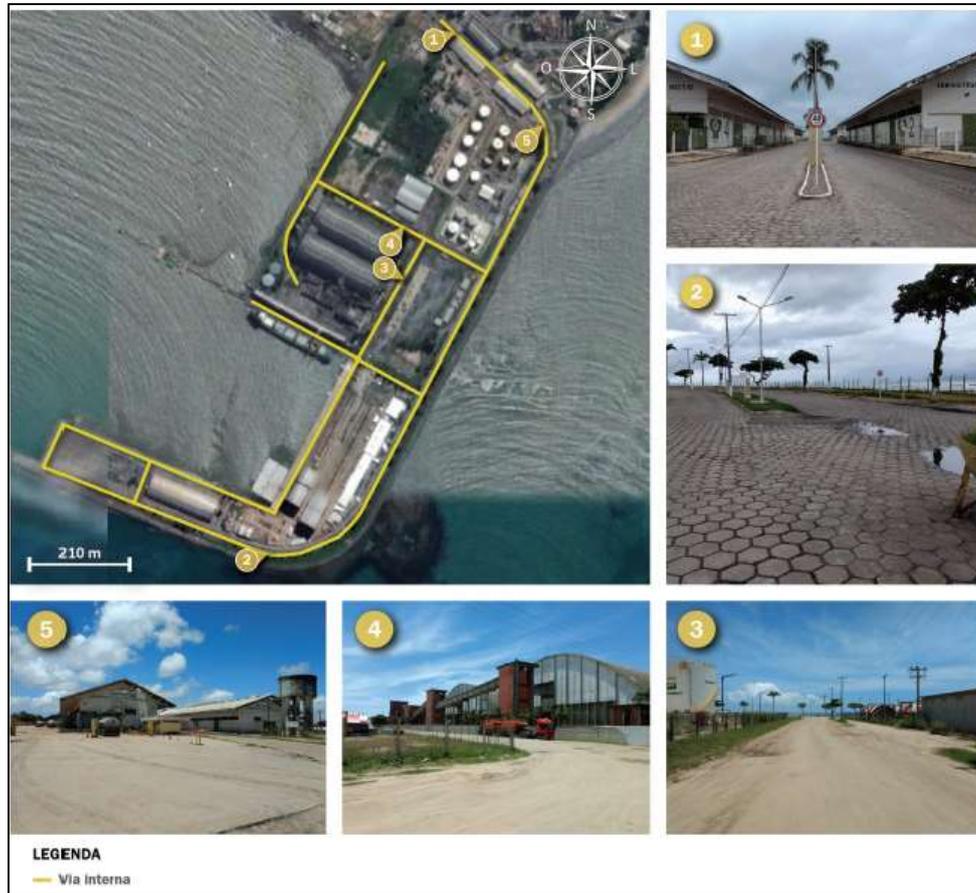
Condições de infraestrutura Plano Mestre Elaboração LabTrans/UFSC (2019).
